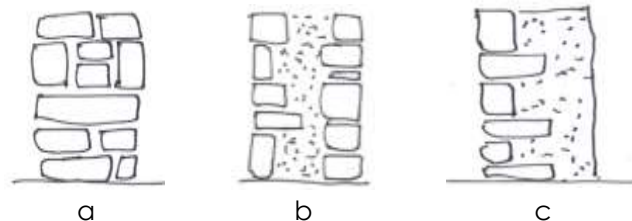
Clasificación de los muros de piedra según su construcción. Fuente: Álvarez, M.A. (2018, p.140)
